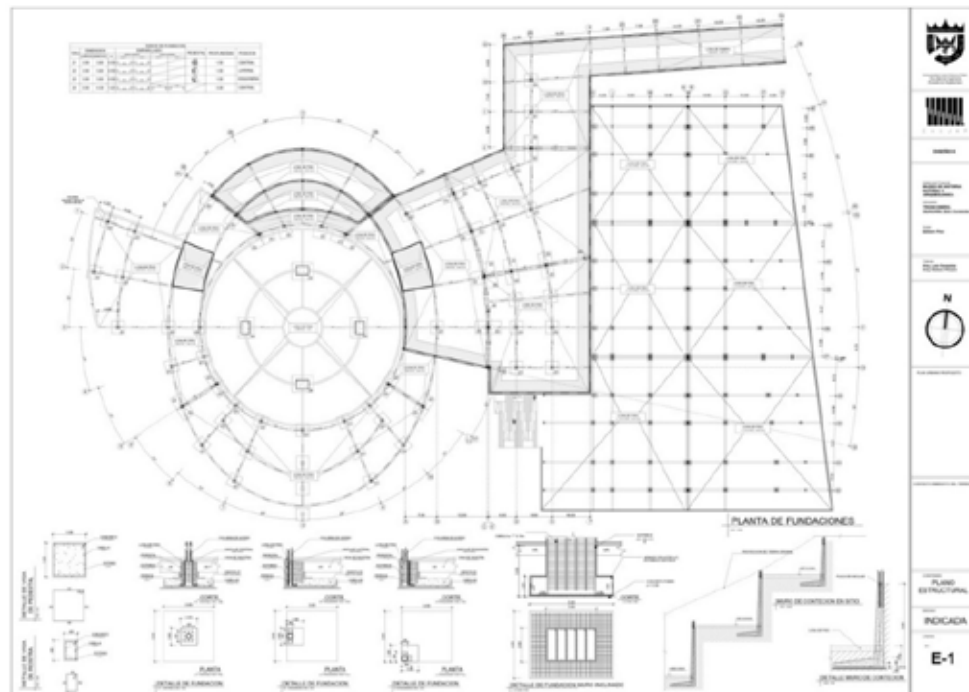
Detalle de infraestructura. Fuente: Autor (2021)
